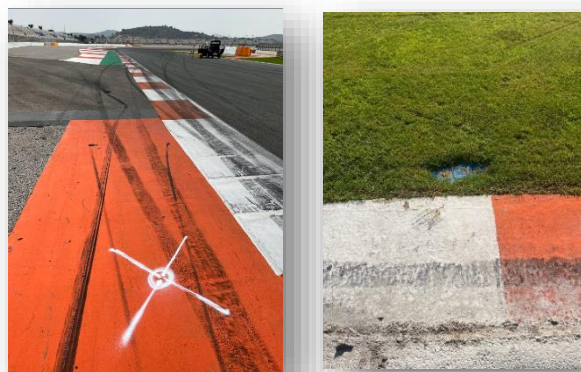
Bases no implantadas sobre pianos, un poco alejado de la pista. Fuente: Elaboración propia
